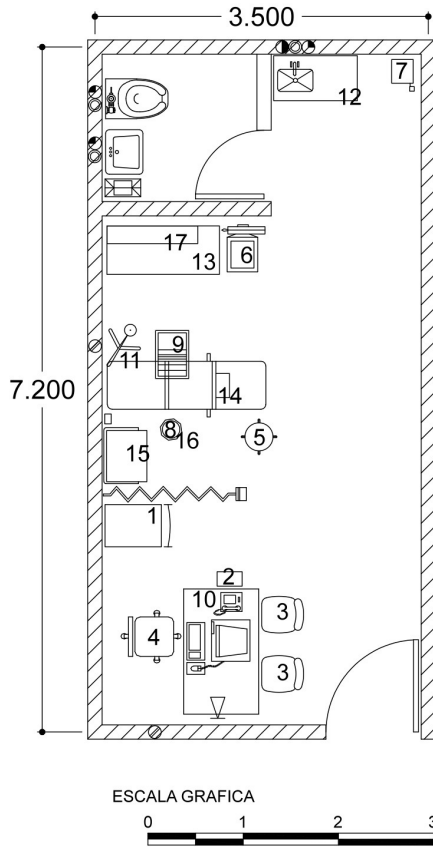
Planta arquitectónica de detección oportuna de cáncer.
